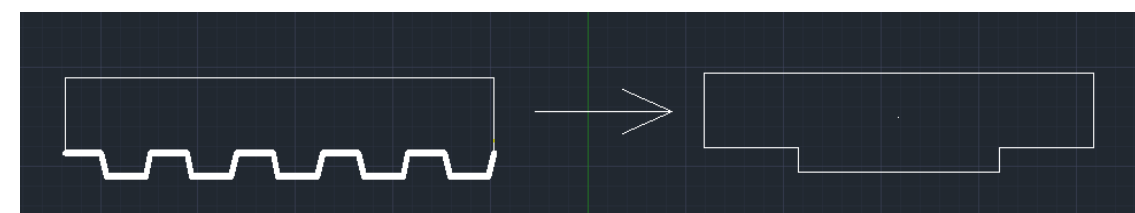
Figura XI: SECCIÓN DE LA LOSA CONSIDERADA EN EL CÁLCULO
